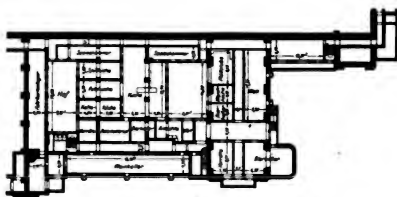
Empfangsgebäude Wiesbaden. Hauptgrundriß.
